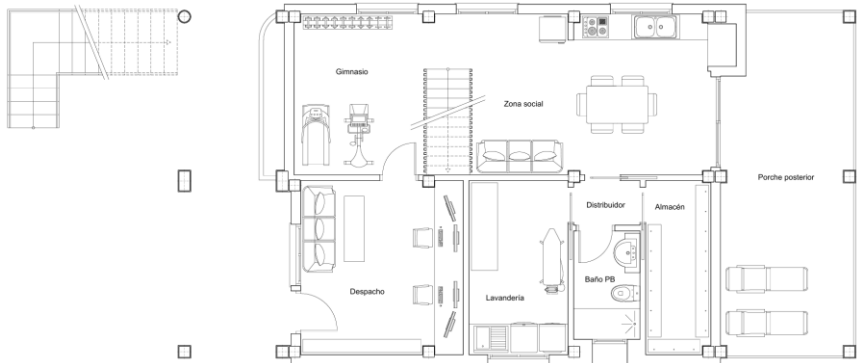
Distribución planta baja reformada. 2024. Fuente: Propia
